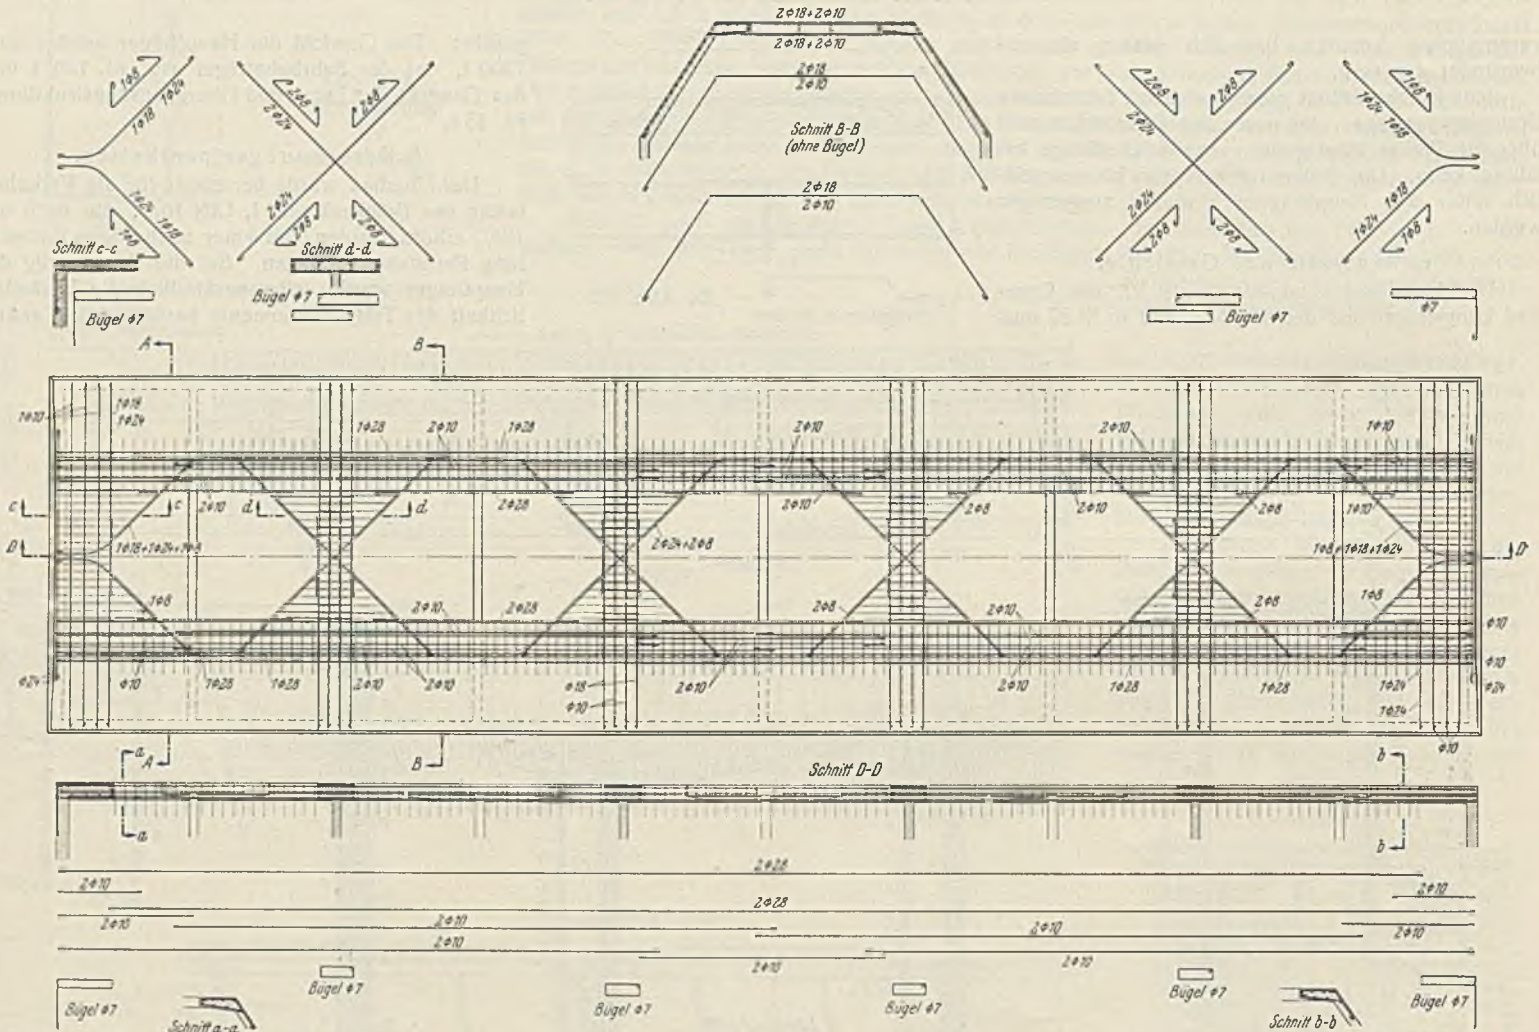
Senkkasten für den Pfeiler C'. Bewehrung des Horizontalträgers.
